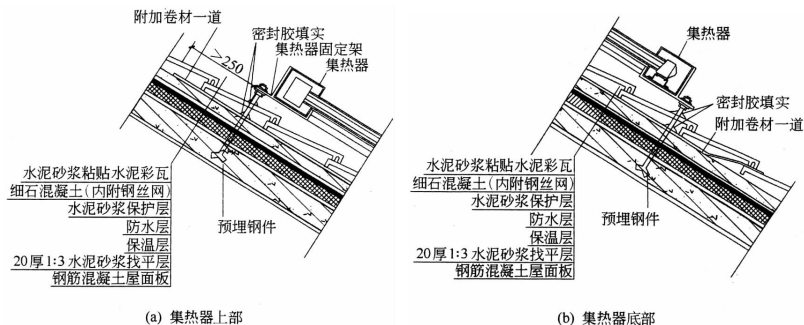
1 平板型集热器架空屋面细部构造示意
